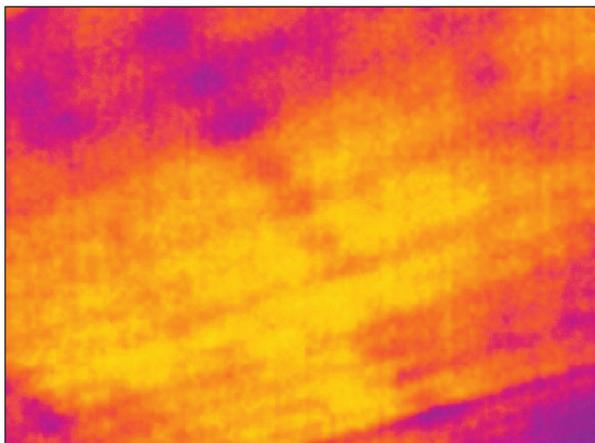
La medesima scansione del plafone è stata individuata anche nell'Aula 7 al piano terra.
